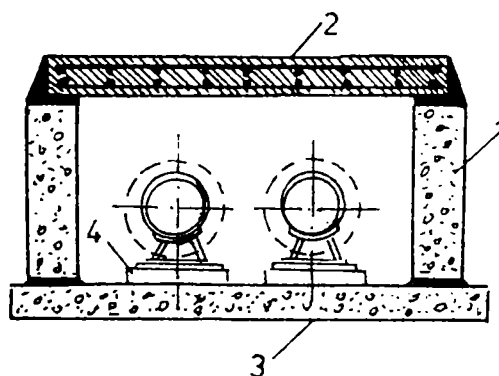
Canale nevizitabile:1-bloc din beton;2-placă de acoperiș din beton armat; 3-placă de fund;4-suport conductă
